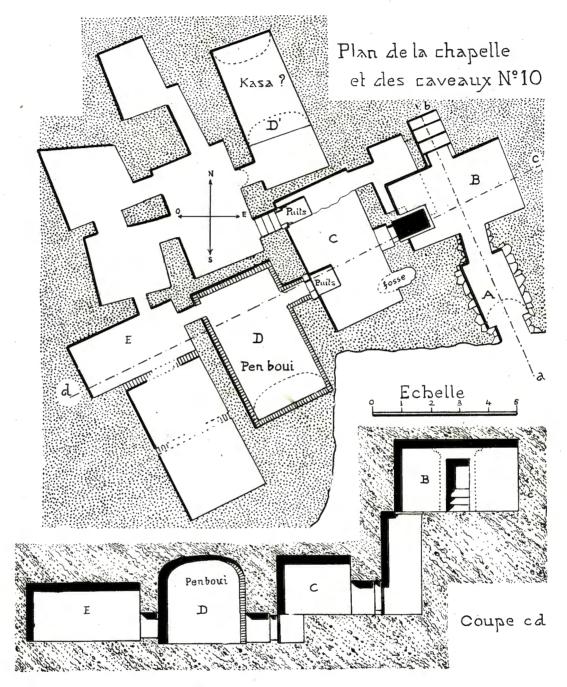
Plan et coupe de l'hypogée de la tombe n° 10,
